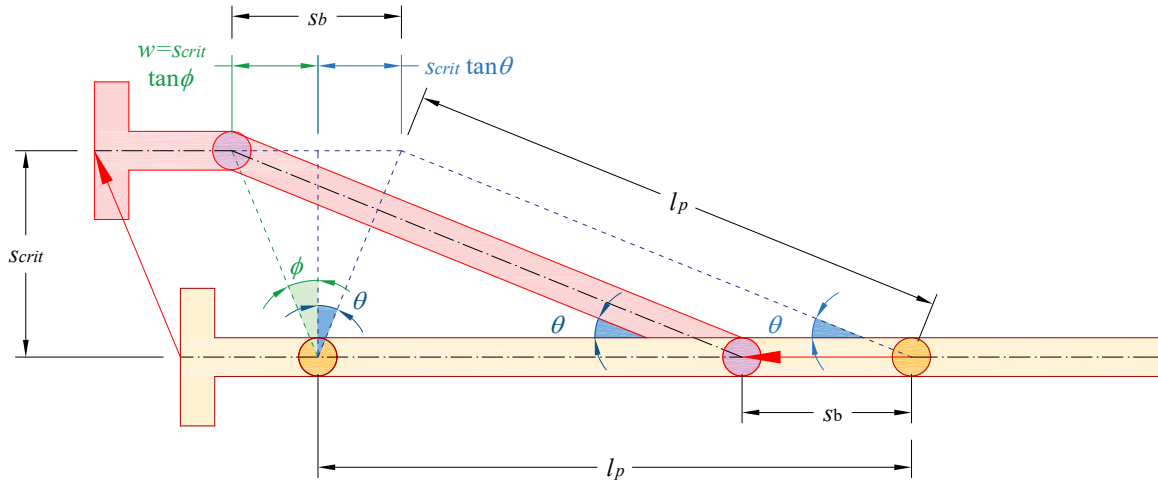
Configuração geométrica do ferrolho formado em armaduras da interface.
